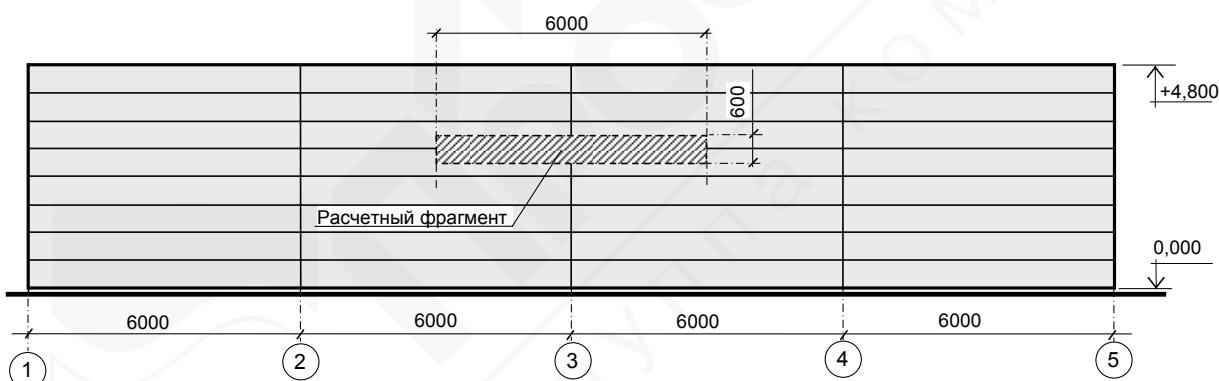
Схематичный фасад проектируемого здания (к примеру Е1)
